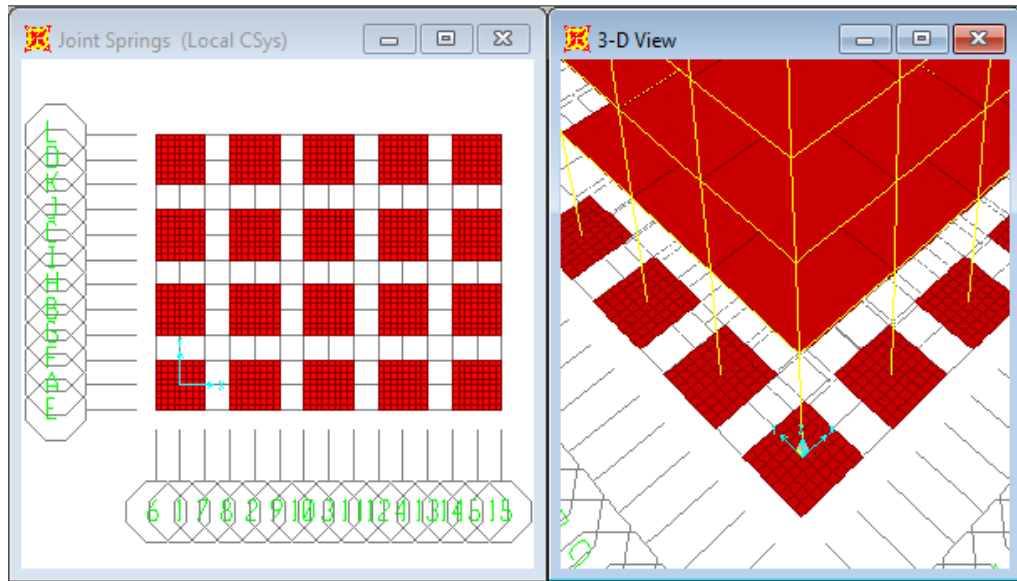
Maillage des semelles isolées pour (R+6).
